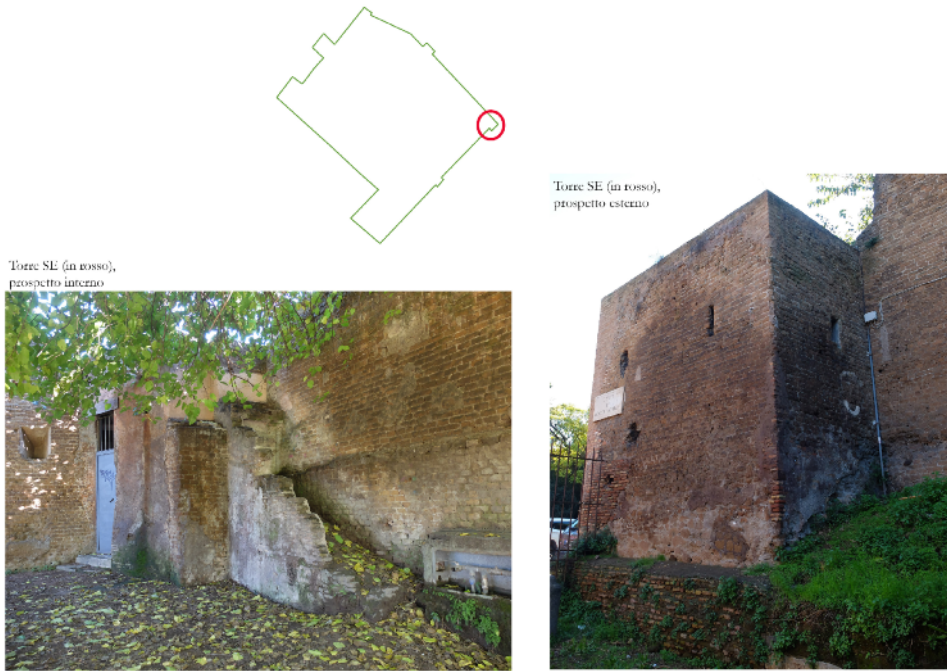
Cinta del Giardino degli Aranci, torre SE: prospetto interno ed esterno, e sua localizzazione in pianta (foto, pianta e grafica di E. Santella).
